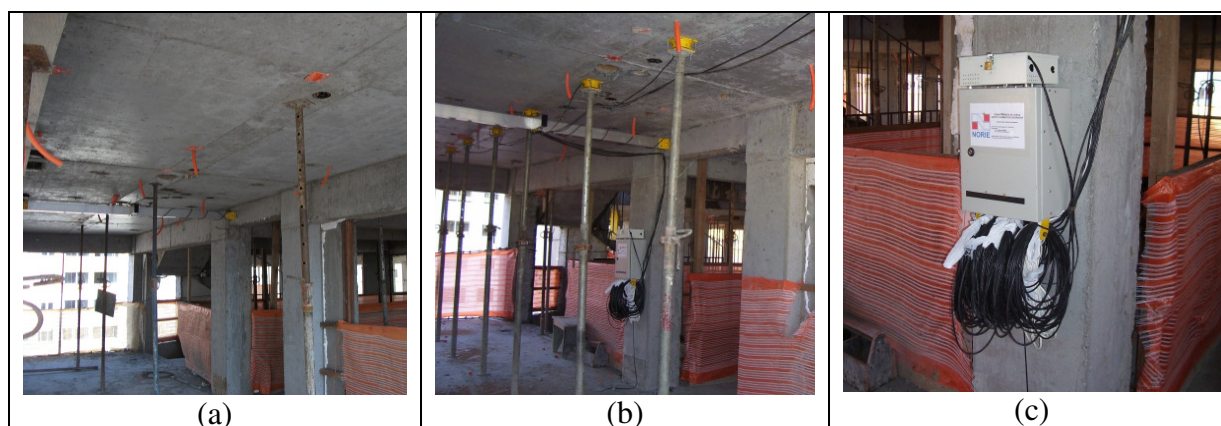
montagem do ensaio de campo. (a) visão geral do pavimento com as reescoras instaladas pelos operários da obra, (b) visão geral do pavimento com as reescoras instrumentadas, (c) central de aquisição de dados
